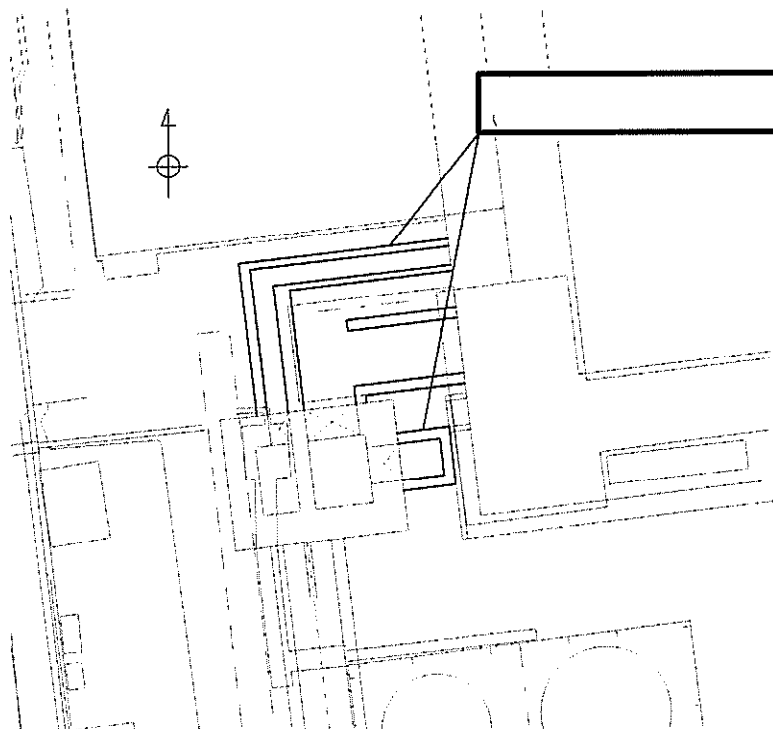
(2) カルバートの平面配置図（拡大図）
